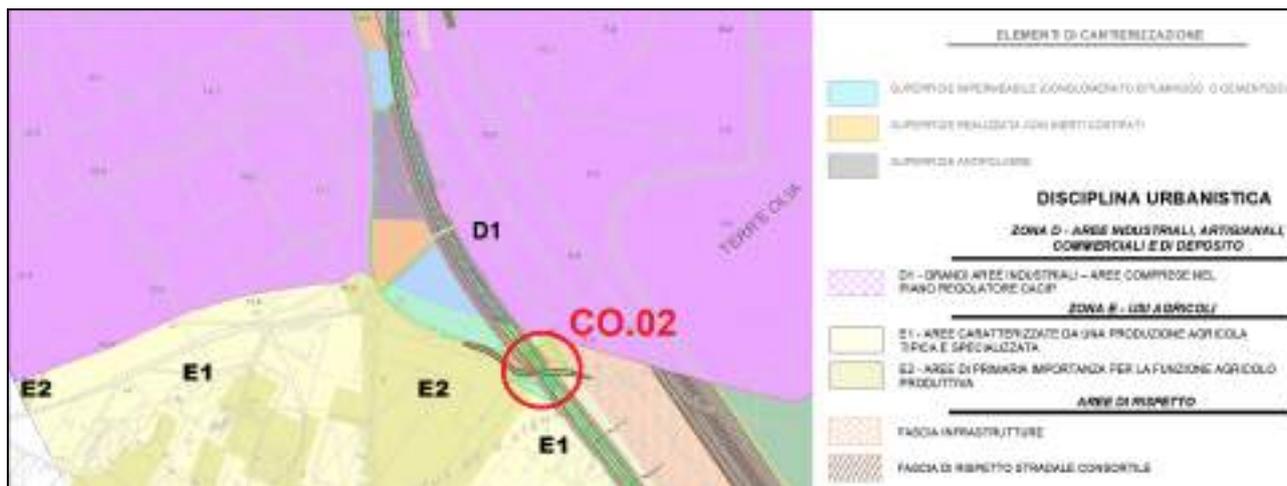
Sovrapposizione del tracciato e delle aree di cantiere operativo-stoccaggio sulla perimetrazione urbanistica – Cantiere Operativo CO.02.
